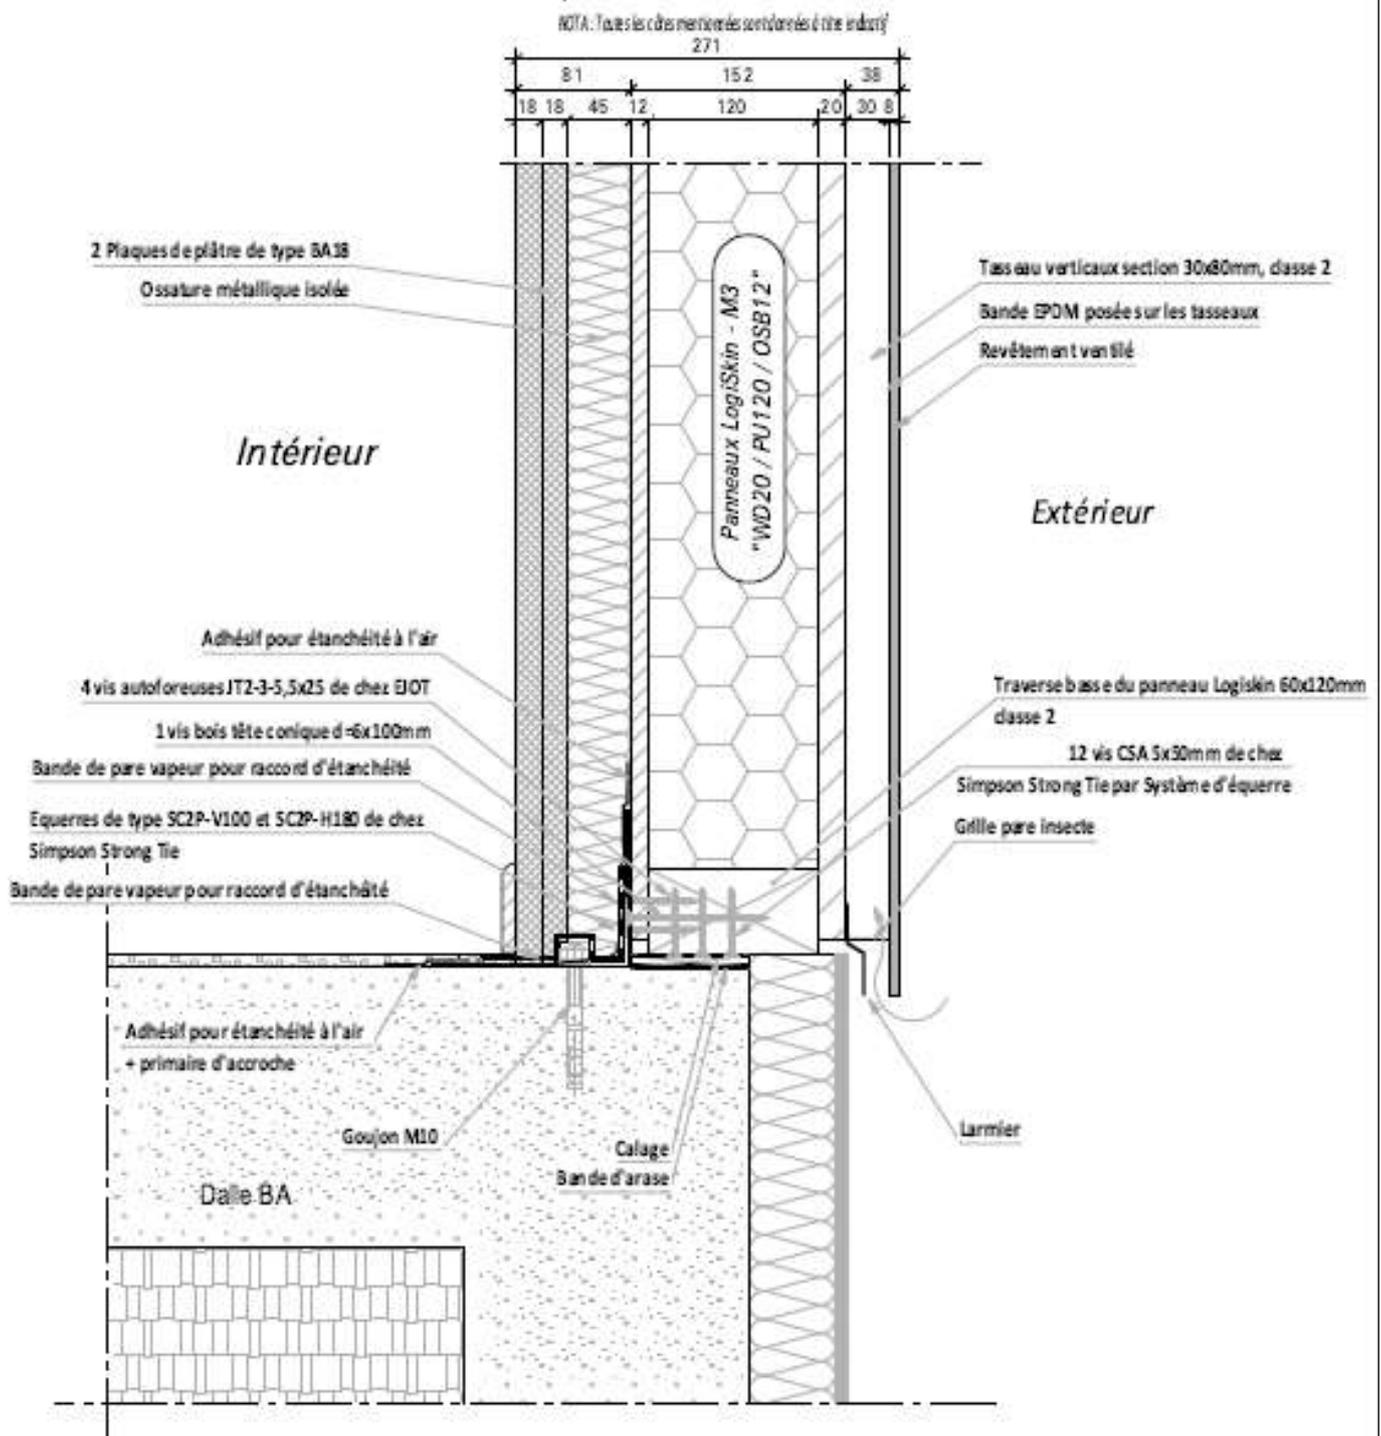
Détail CV-1.2 – détail pied de façade – Mode de pose 2-2
